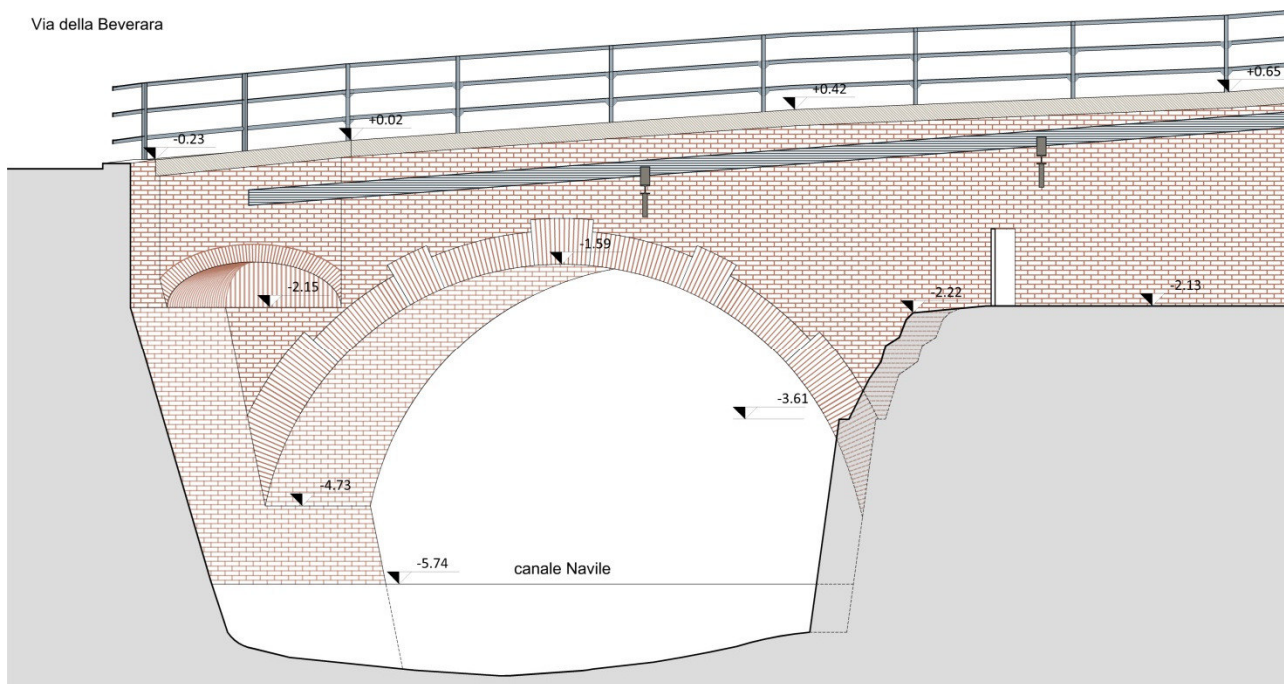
Prospetto sud, ponte in muratura – Come il rispettivo fronte nord, la struttura è in mattoni pieni di laterizio, sormontata da un cordolo intonacato che contiene il manto in asfalto. Le staffe che reggono le tubazioni sono in ferro, infisse nella muratura.
